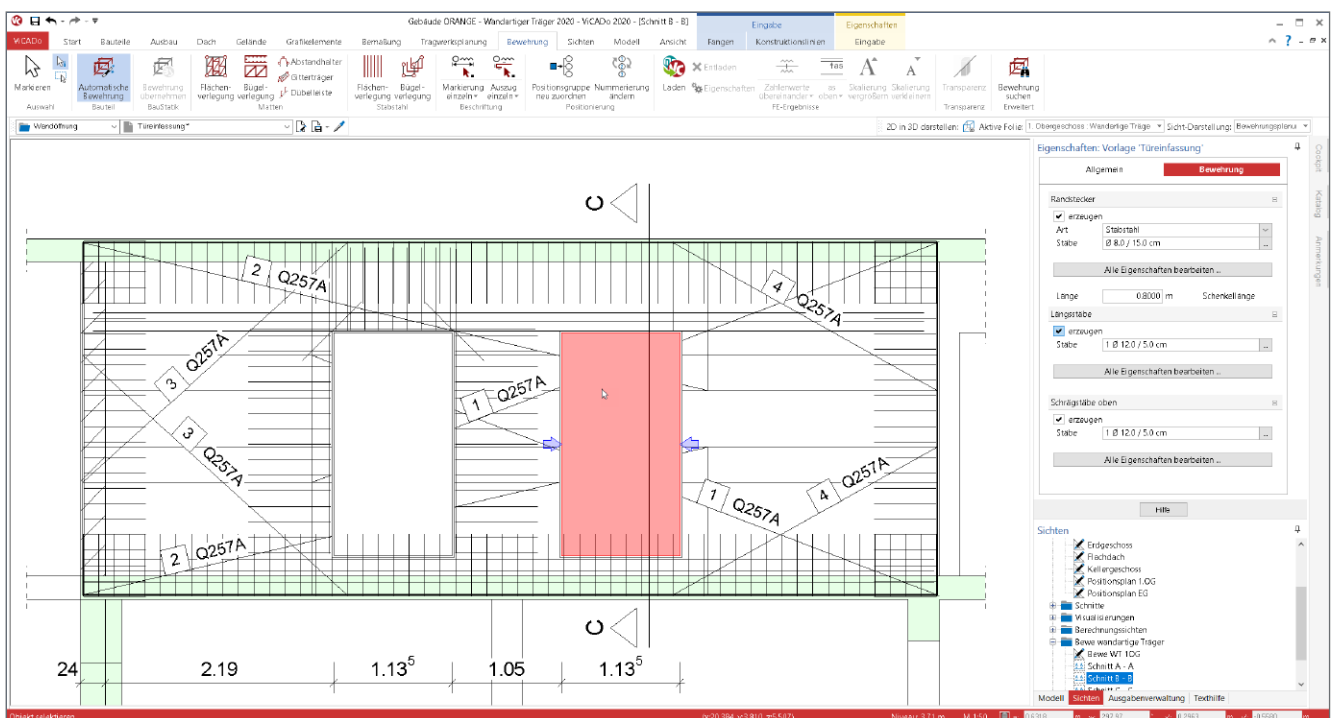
Automatische Bewehrung zur Modellierung der konstruktiven Bewehrung der Aussparungseinfassung
